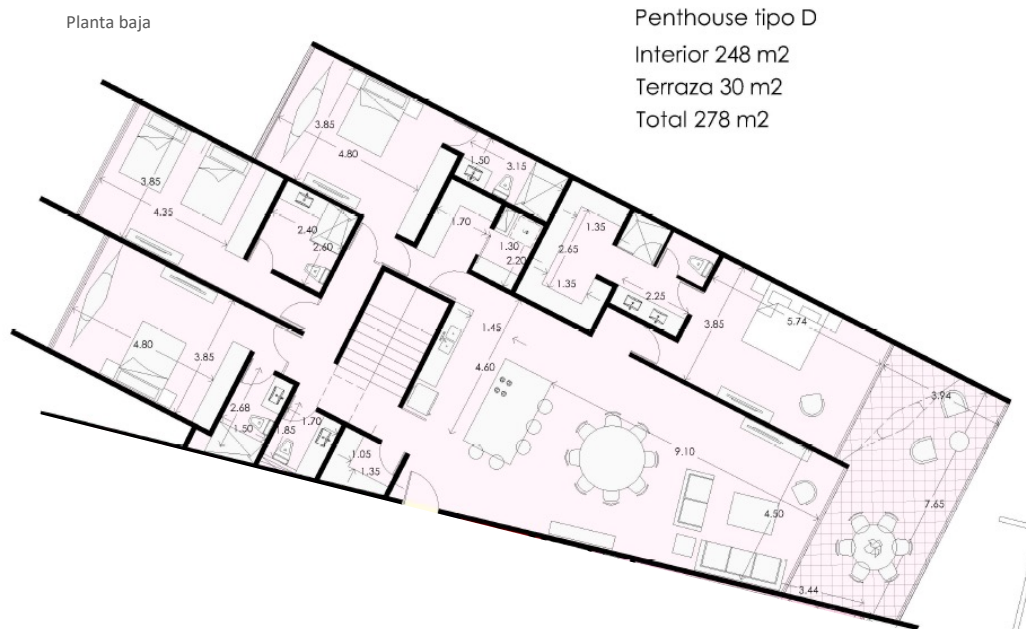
PLANTA BAJA PENTHOUSE TIPO D.
